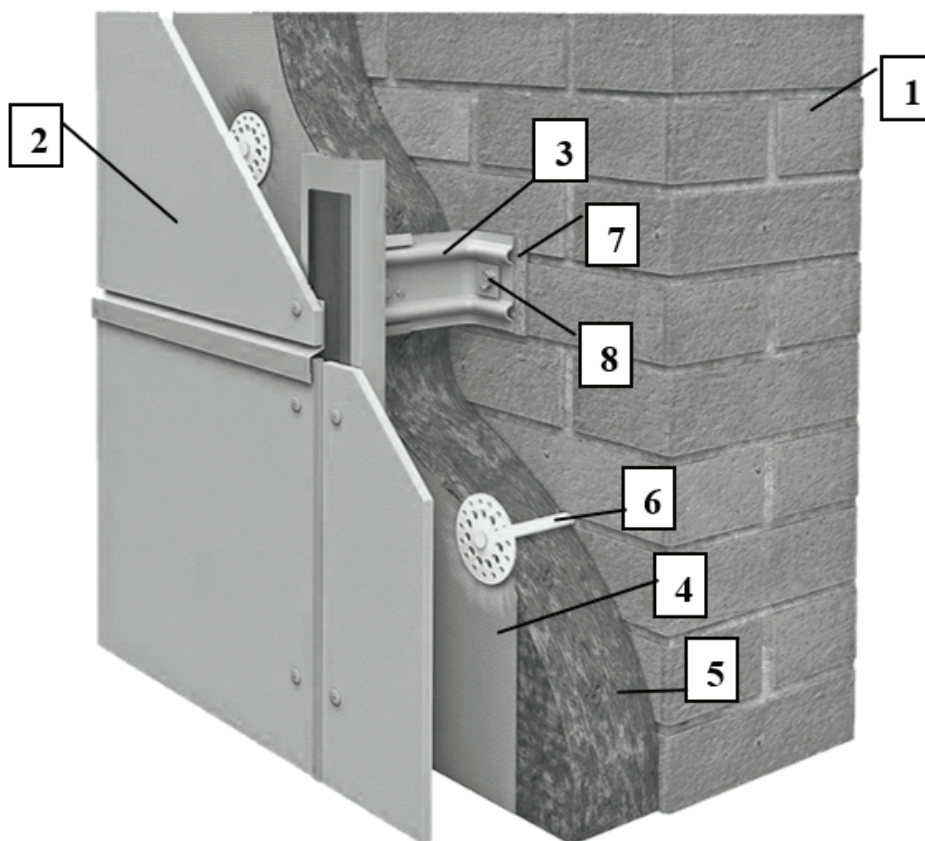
Конструкция навесного вентилируемого фасада со стальным каркасом: 1 — ограждающая конструкция, подлежащая утеплению; 2 — облицовочный материал; 3 — стальной профиль; 4 — пароизоляция; 5 — минераловатный утеплитель; 6 — пластиковый дюбель; 7 — изоляционная прокладка; 8 — болт крепления
